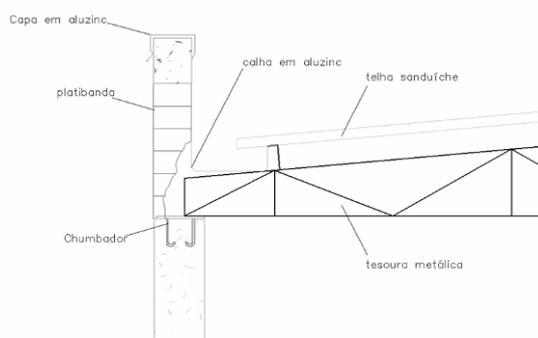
Corte detalhado do apoio da estrutura (DUARTE, 2009)
